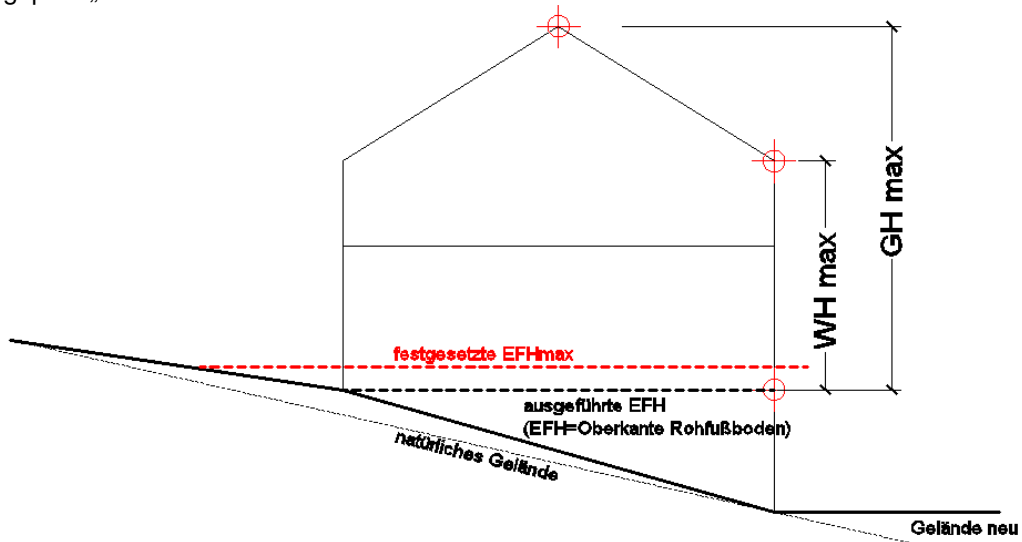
Erläuterungsskizze für BQ 5-8, zweiseitig geneigtes Dach (Satteldach und Walmdach)
